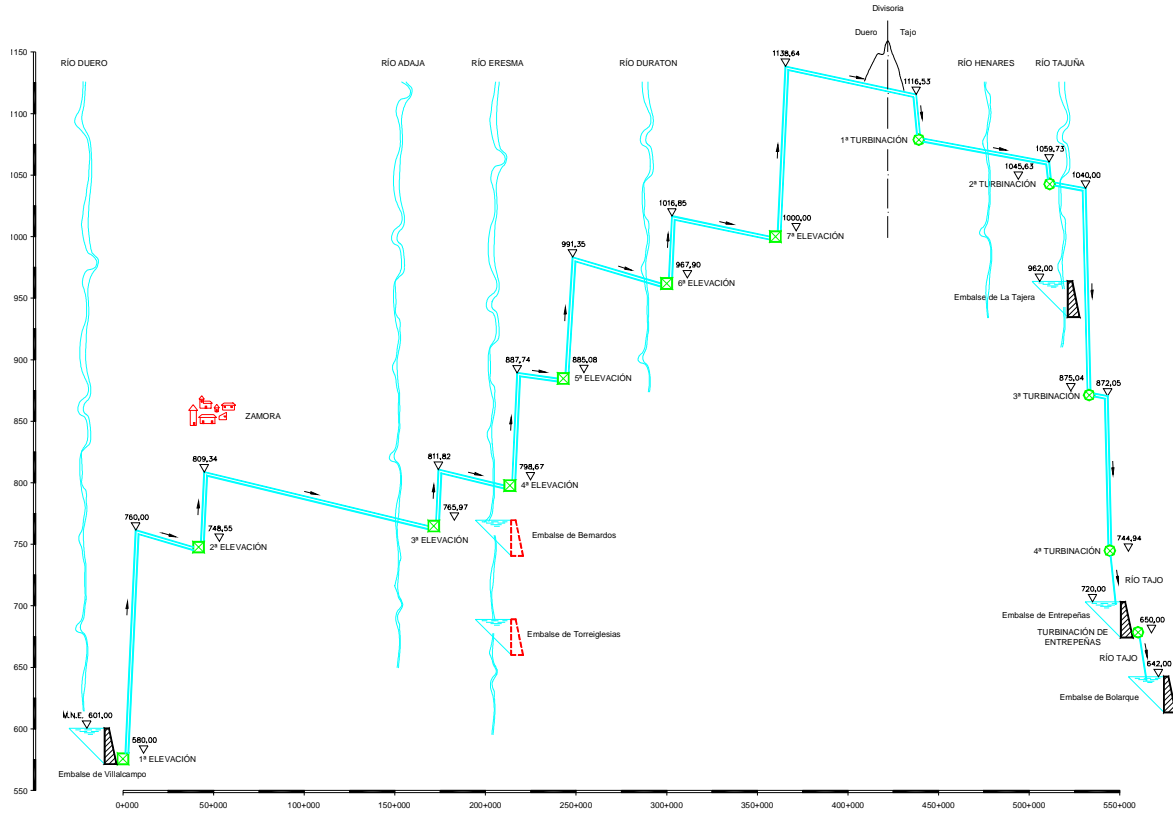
Conducción Bajo Duero - Bolarque. Esquema en alzado
